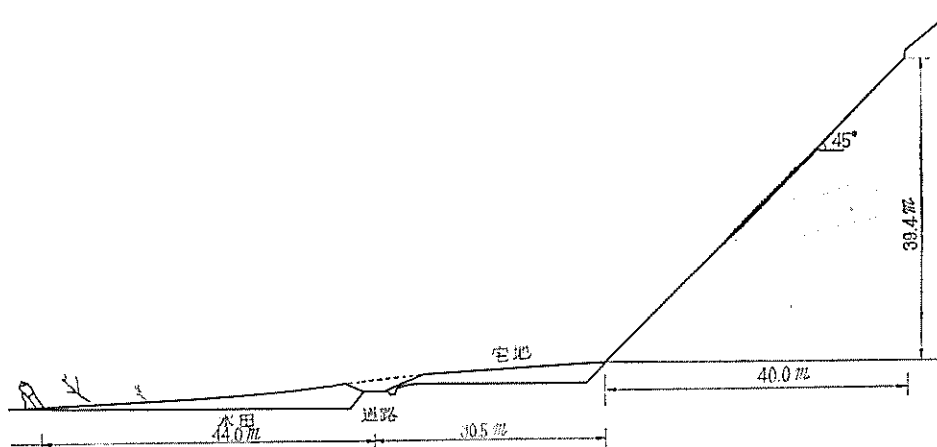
崩壊断面図（調査地点 No.2 の B-B 断面図）
